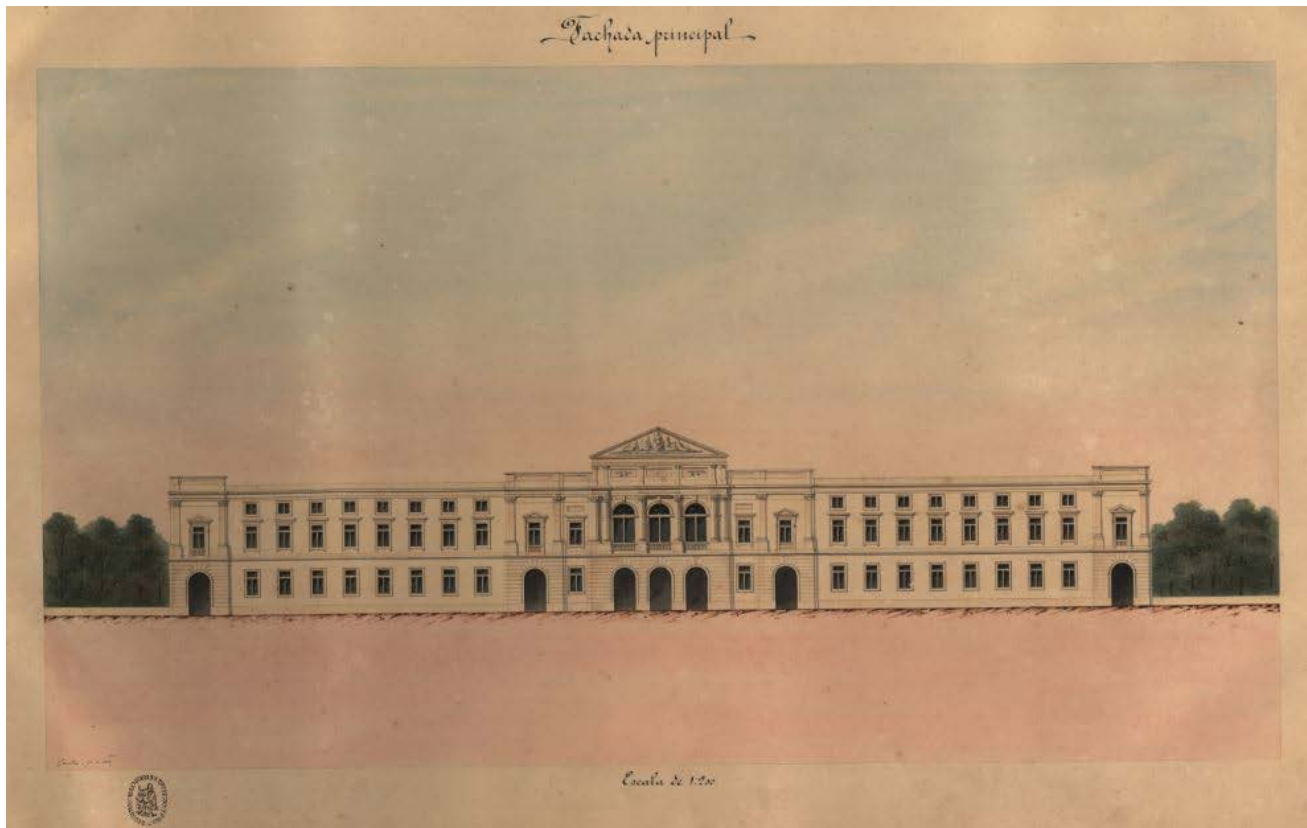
Fachada principal, Palácio da Justiça. Rafael da Silva Castro, 1876-1879 (?). ANTT, Casa Real, Plantas, Plantas Diversas, Ca-PT-TT-CR-Plantas-Pasta23-N566\_c0003.
